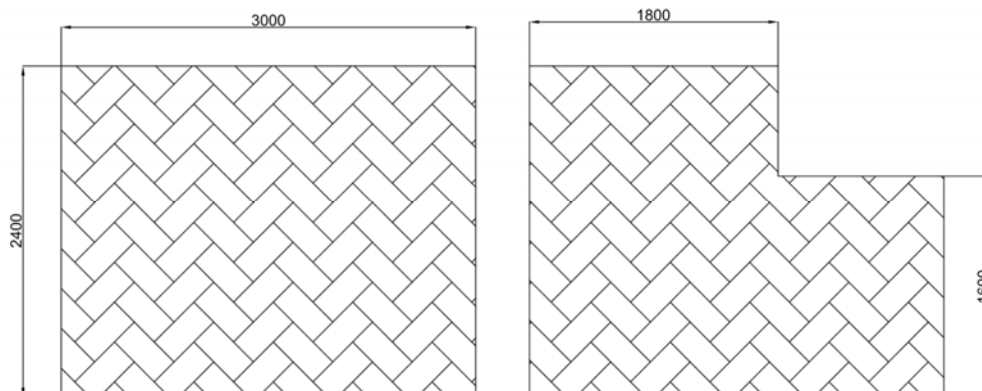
Plantas de la estructura base fija a modelar en SAP 2000.
